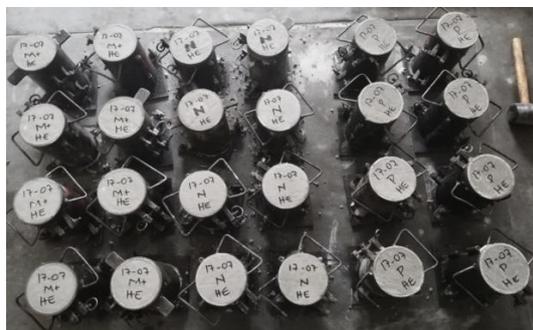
Cilindros de Hormigón (Arellano & Fierro, 2018)
